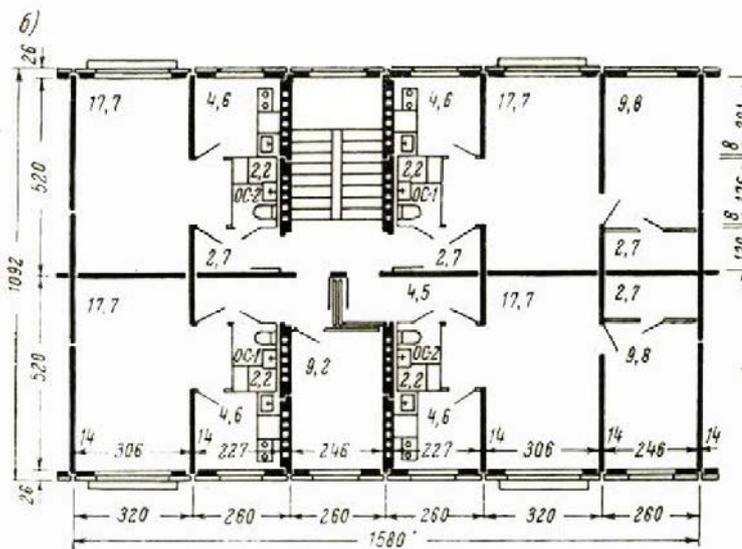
Типовой план этажа секции 5-тиэтажного кирпичного дома
